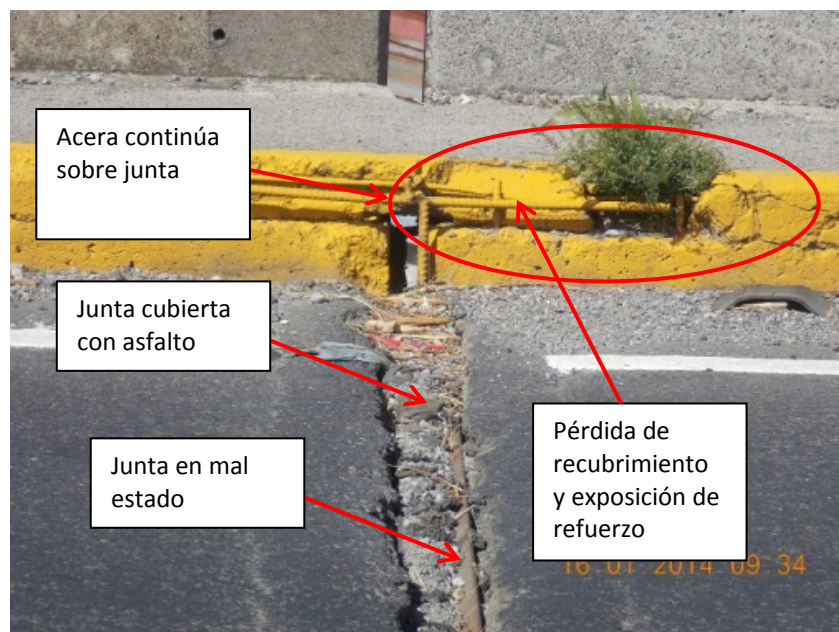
Acera en voladizo sobre junta en el costado oeste y junta cubierta con asfalto entre tramo 6 y tramo 7.
